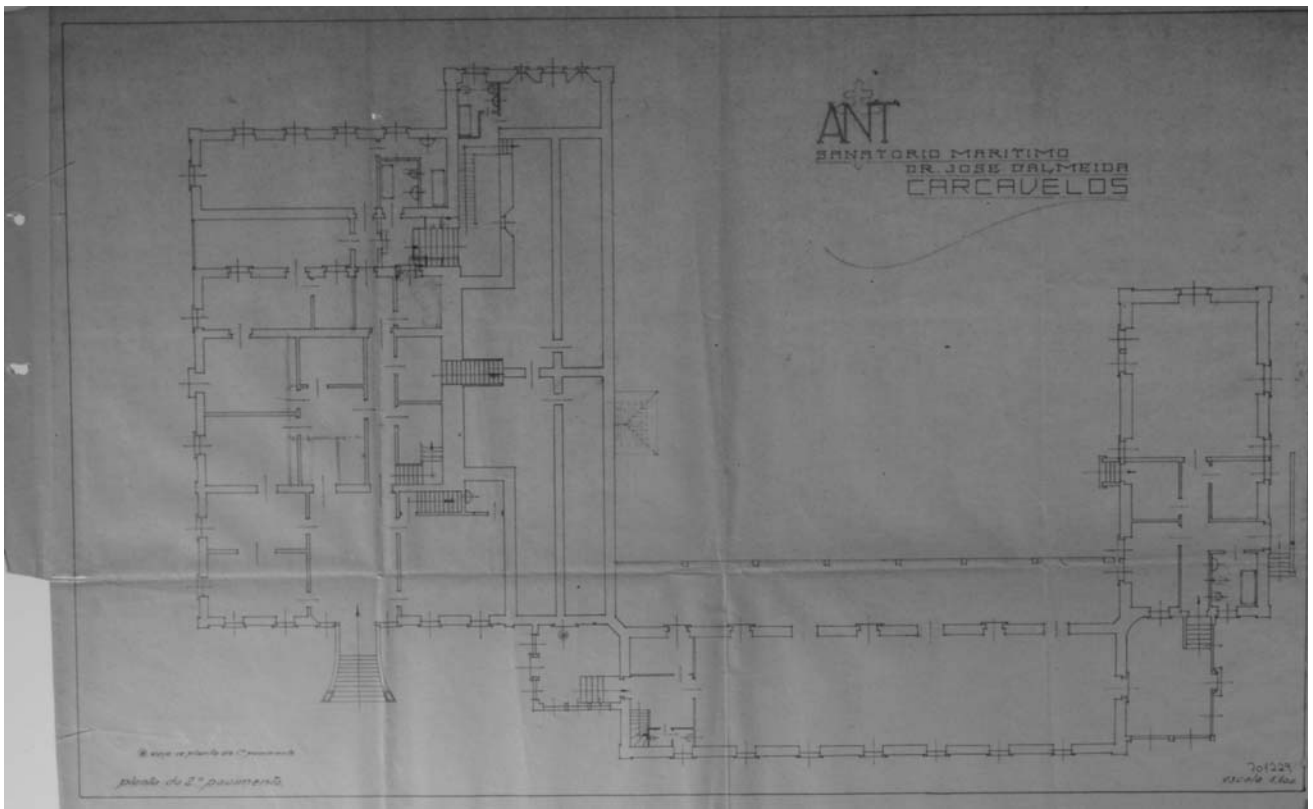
Planta do 2º. Pavimento. SIPA: DES\_701229.
